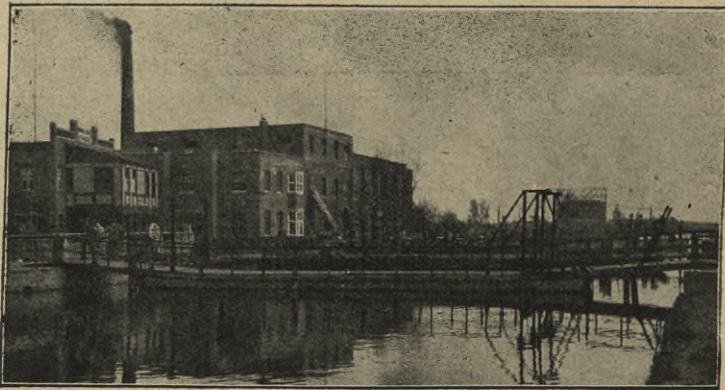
Schwimmende Eisenbeton-Drehbrücke.
